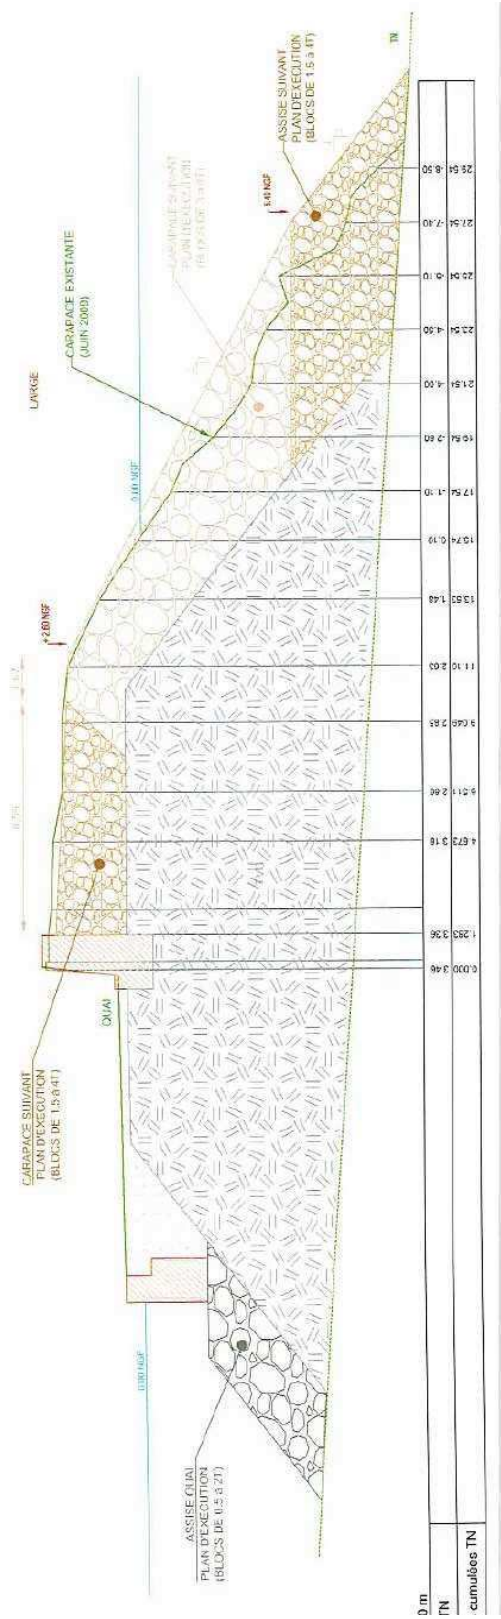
Profil type en section courante Profil P6 (Source : Accoast, 2018 [2])
